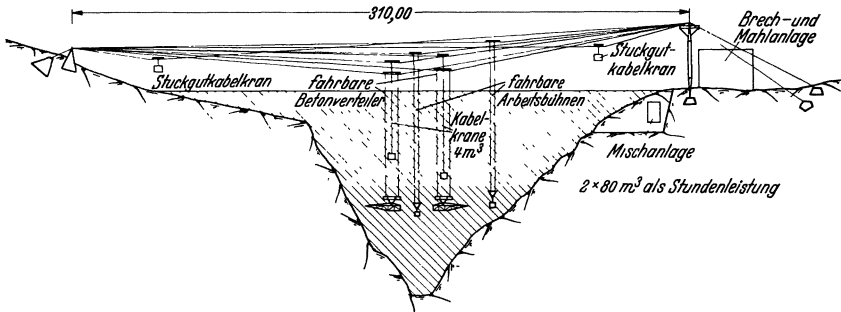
Ansicht der Betonierausrüstung der Esla-Staumauer (Spanien).
